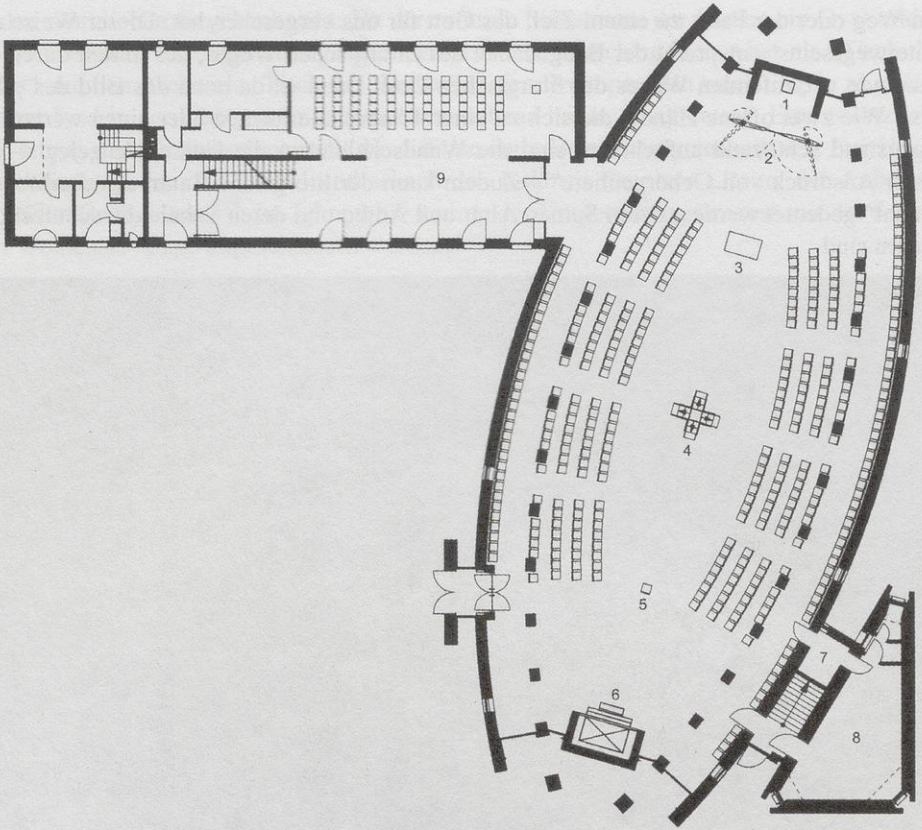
Grundriss der St. Christophorus Kirche in Westerland
